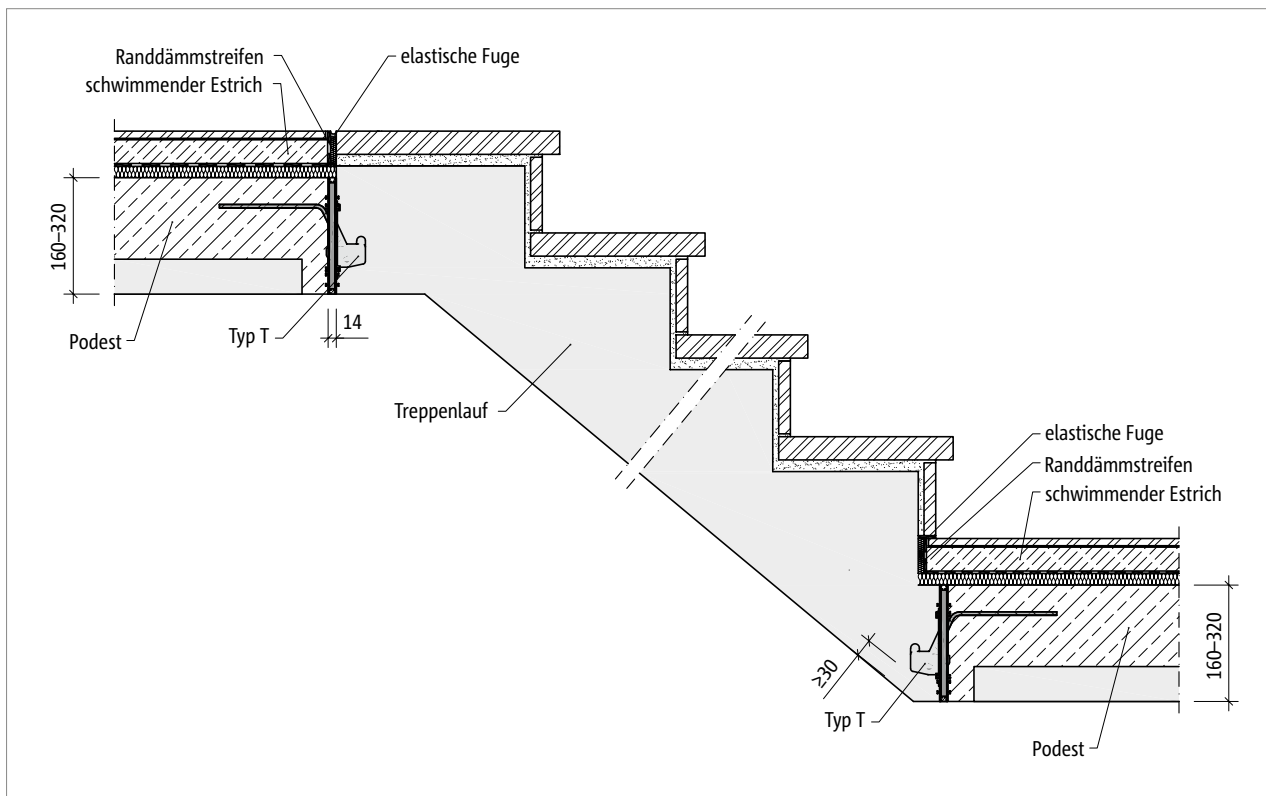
Tronsole® T: Einbauschnitt Fertigteilstufe mit Halbfertigteilpodest
